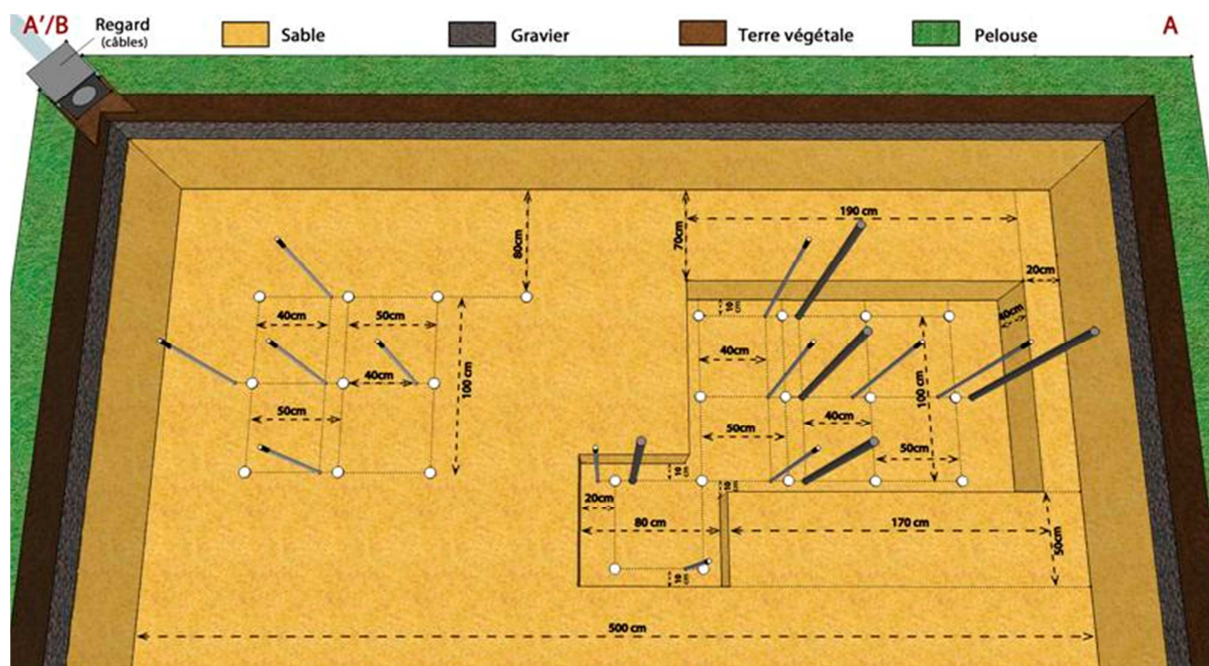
Plan d'installation des capteurs au fond de la fouille du futur massif filtrant
